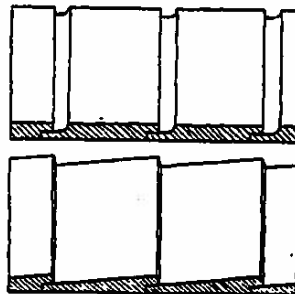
Horizontalt trepanel med høyde kantprofil.
